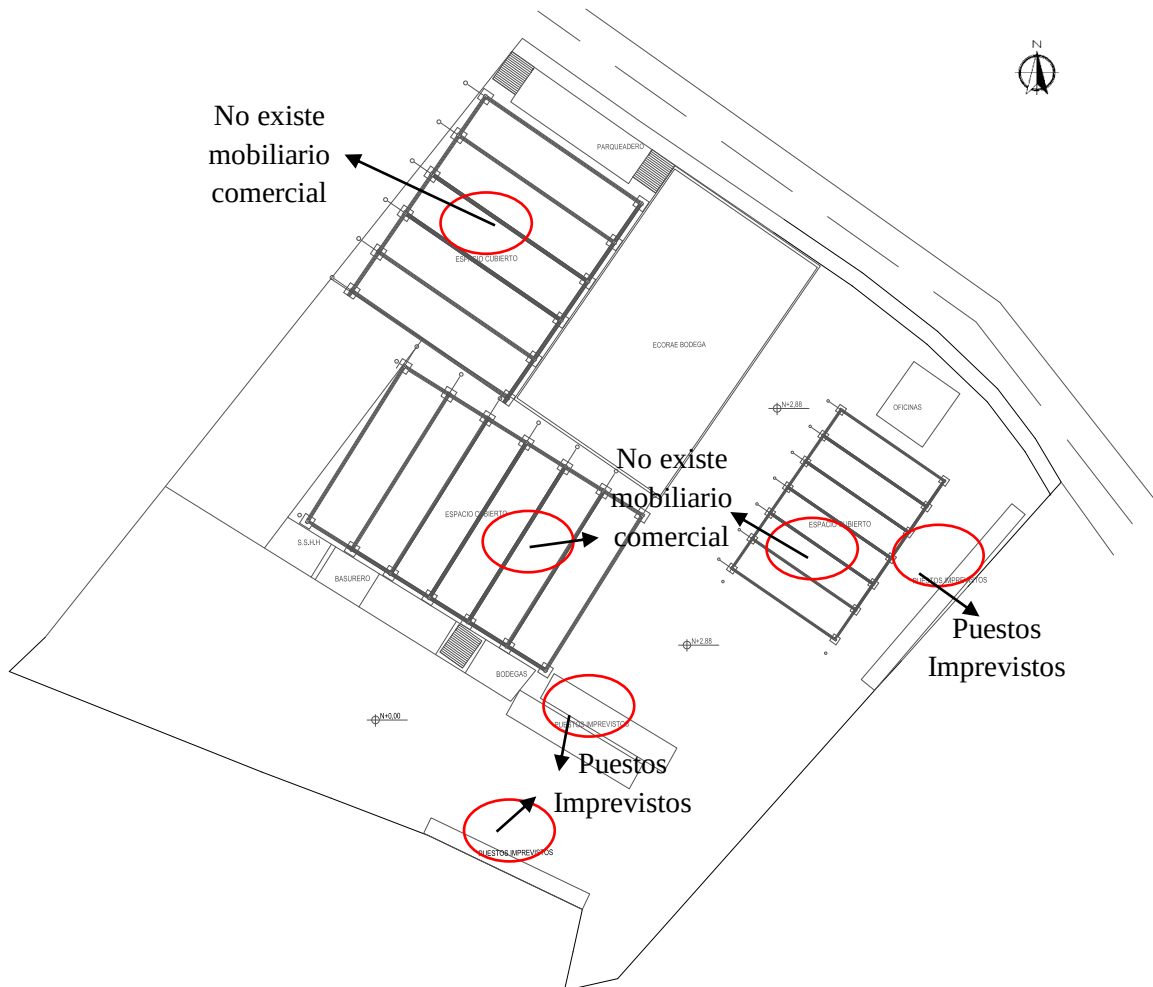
Planta arquitectónica actual de la plaza “Mercado de los Plátanos”
